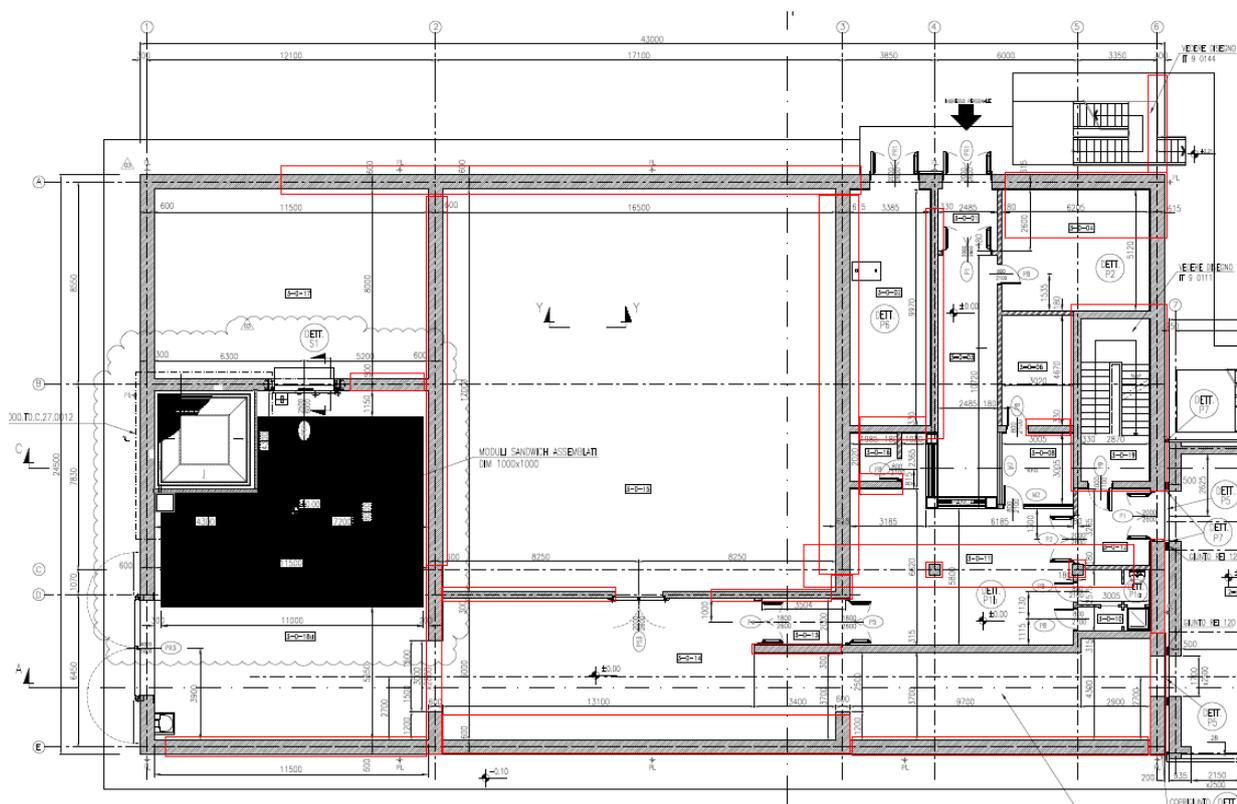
/1 – Planimetria di progetto con indicazione (in rosso) delle strutture in elevazione ad oggi realizzate
